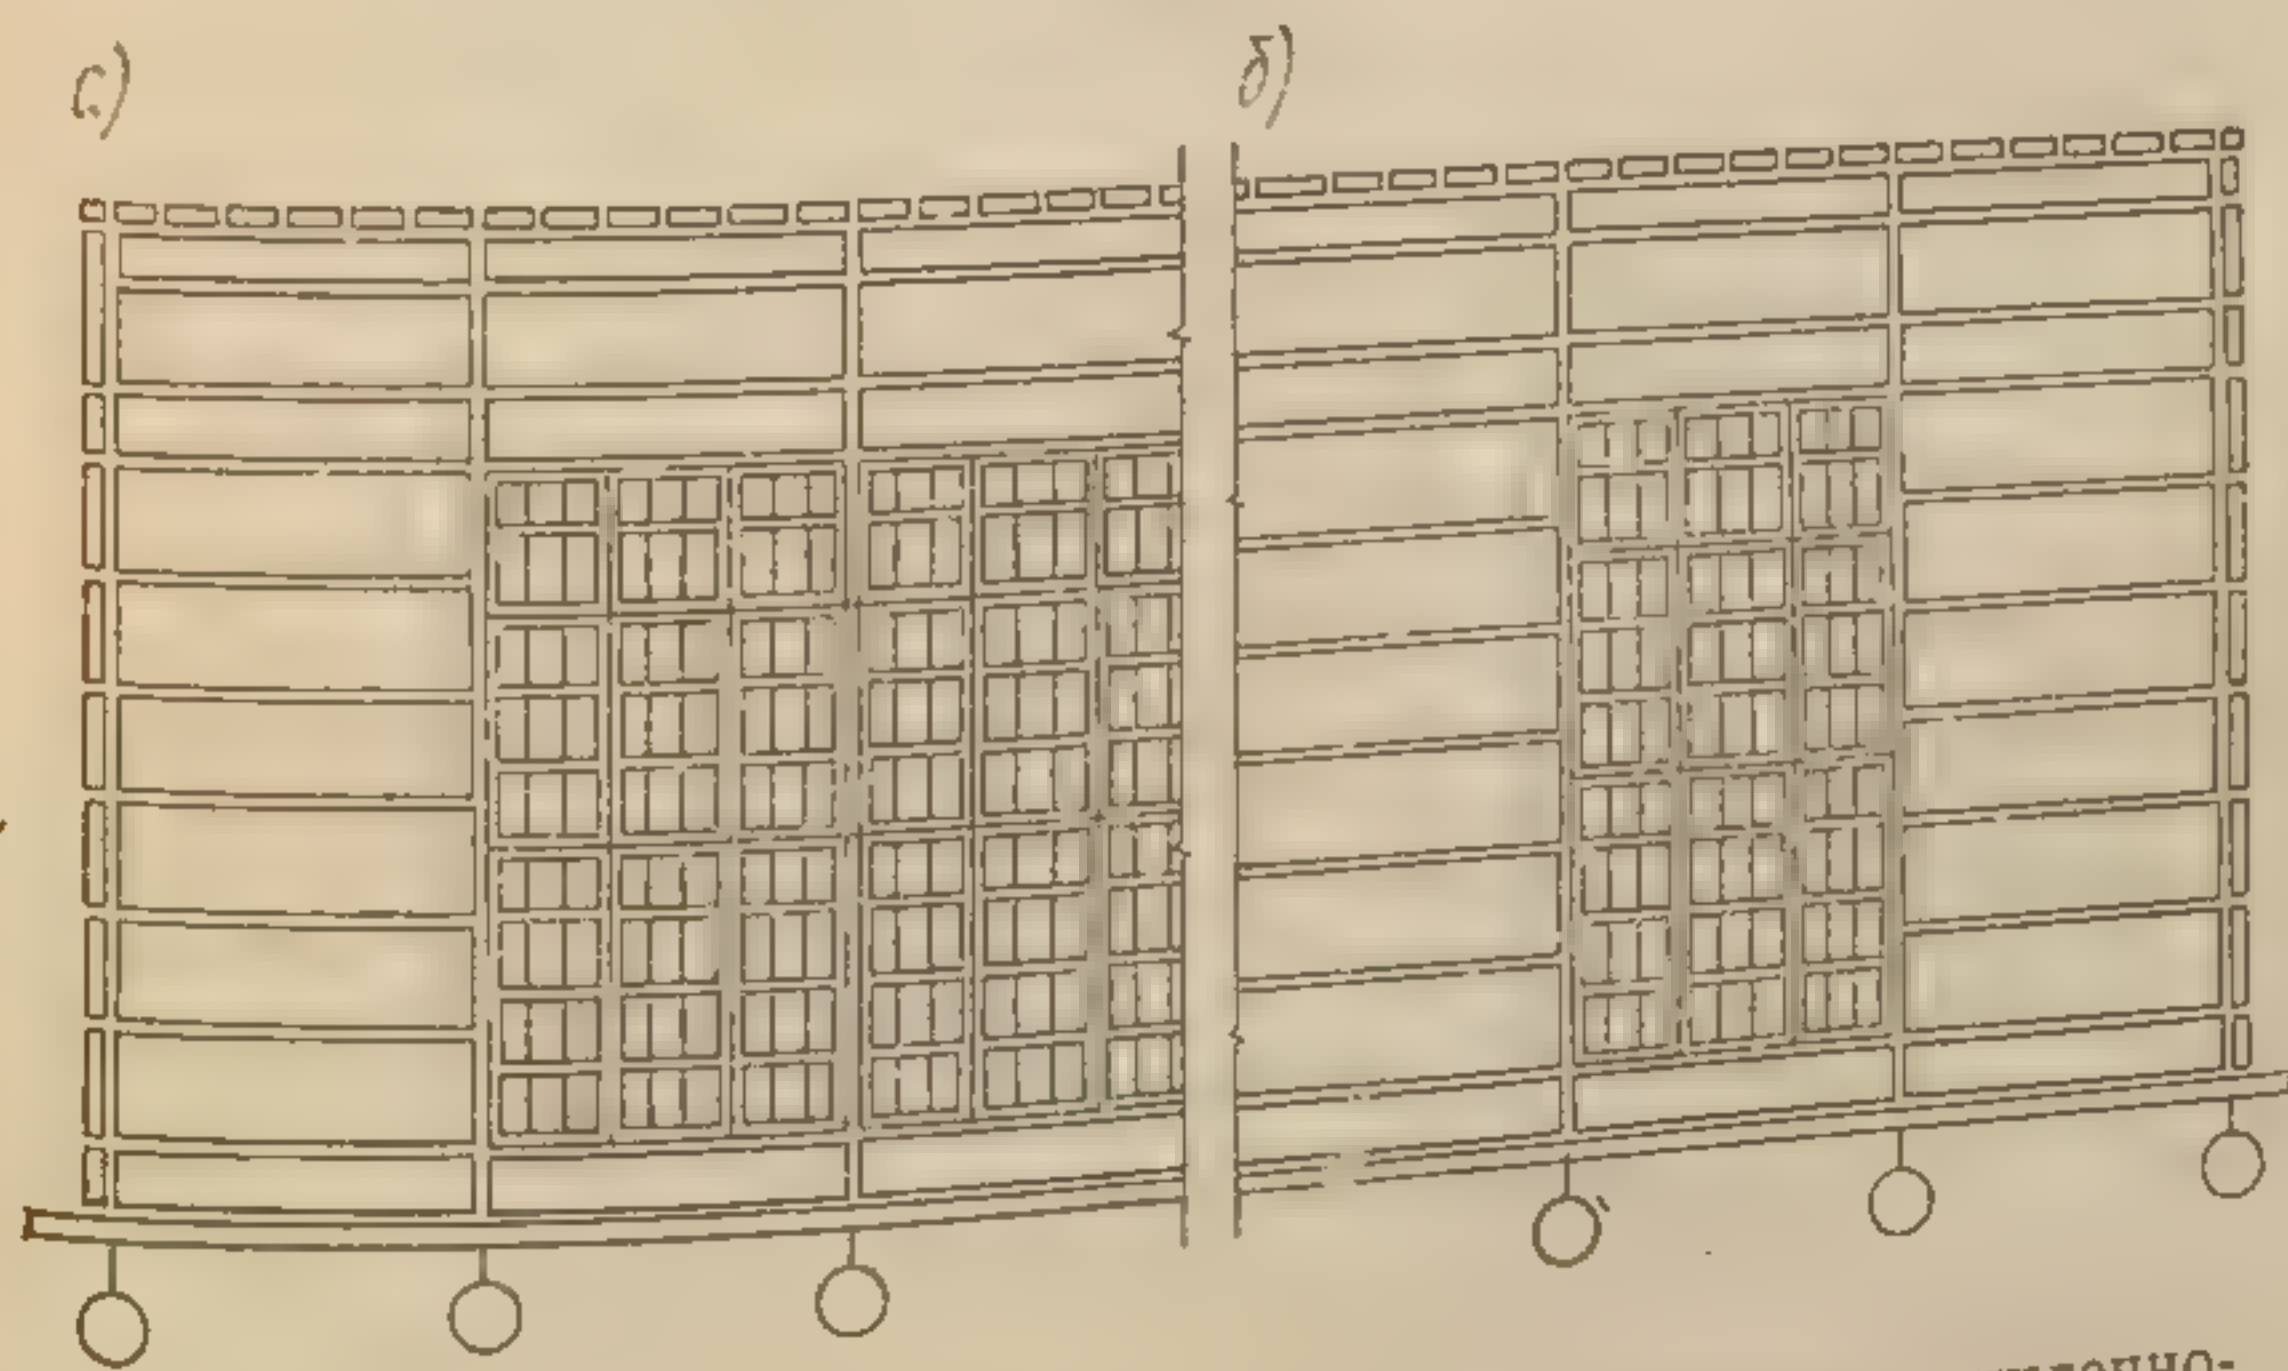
Примеры разрезки стен одноэтажного промышленного здания на панели:
